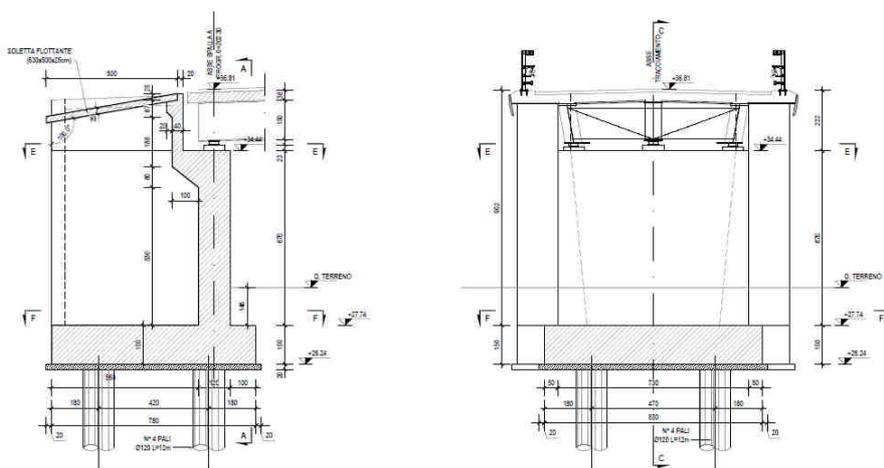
Carpenteria spalle - Svincolo Baracca Manna
